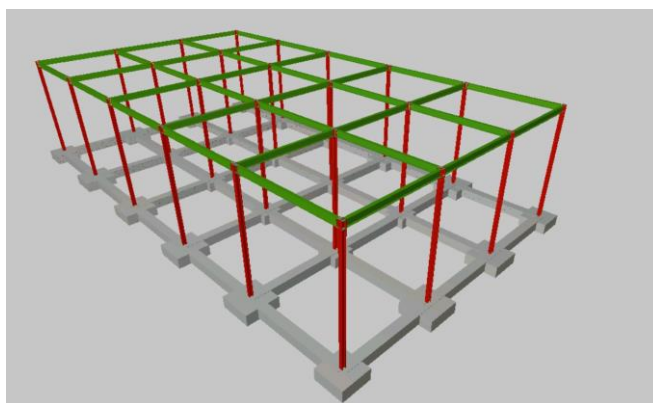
Estructura del edificio principal. Fuente: elaboración propia.
